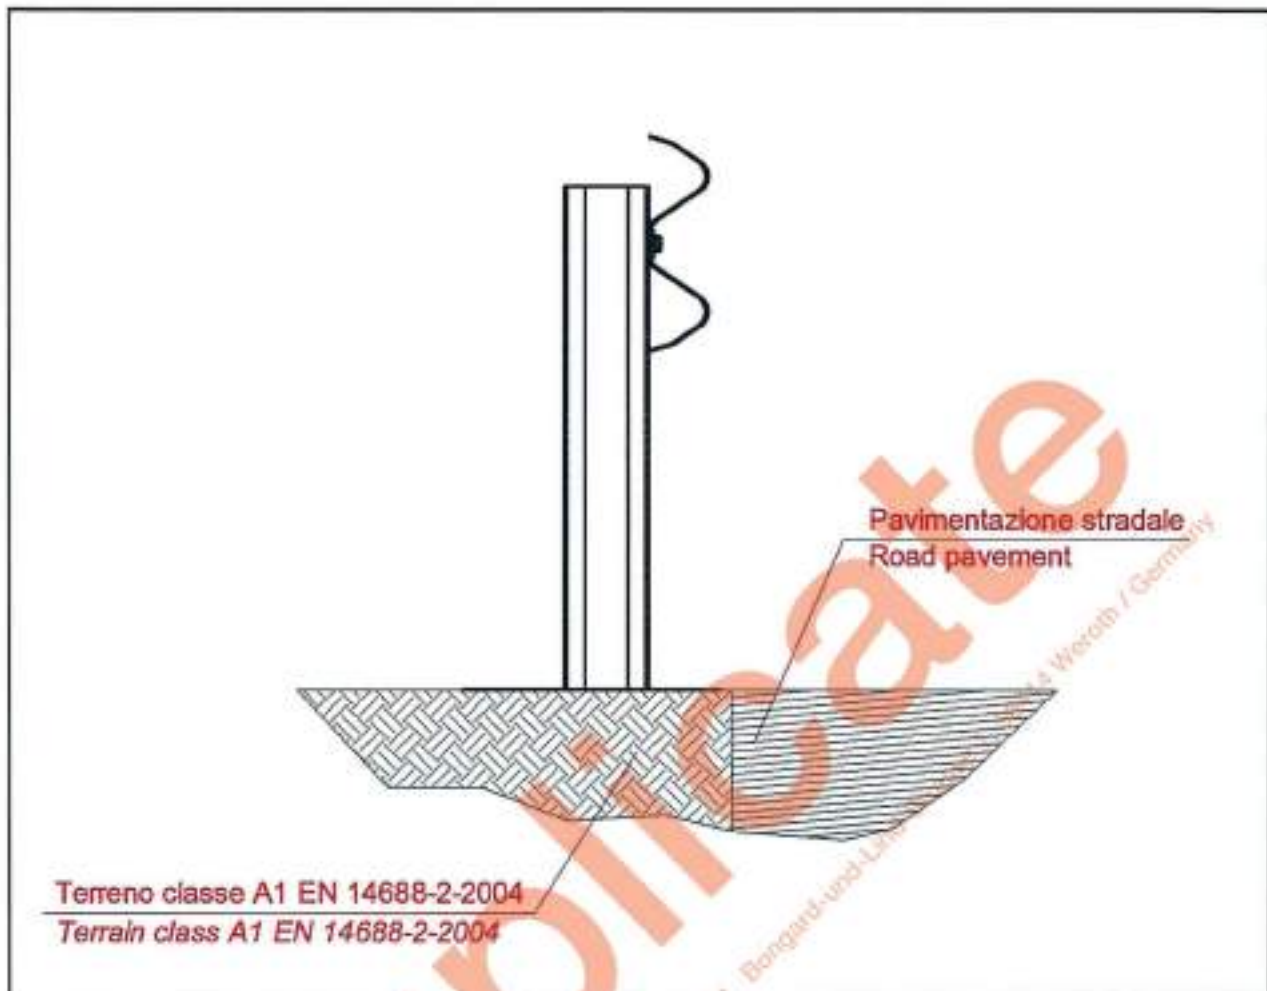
Figure 2 Sezione dell'installazione - The installation section
